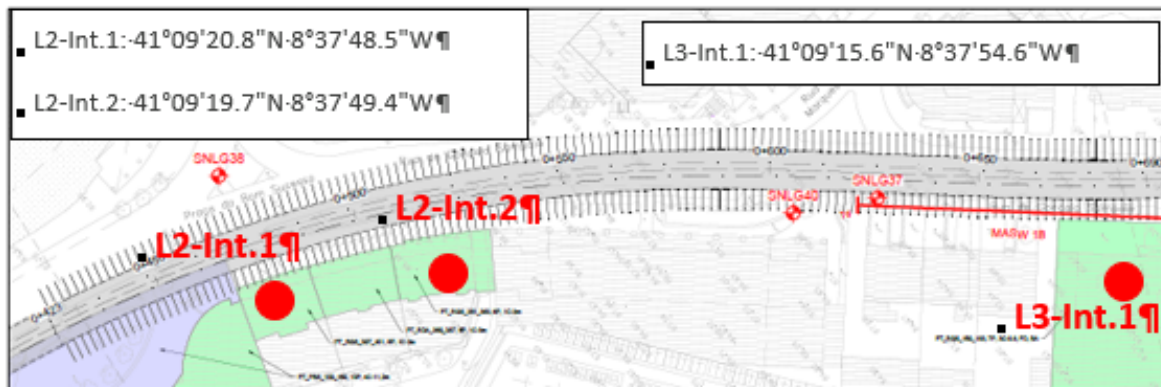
Pontos de monitorização (km 0+423 a km 0+690; vibrações – construção)
